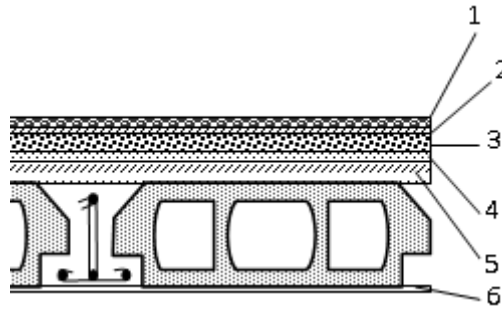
Coupe transversale d'un plancher terrasse inaccessible
